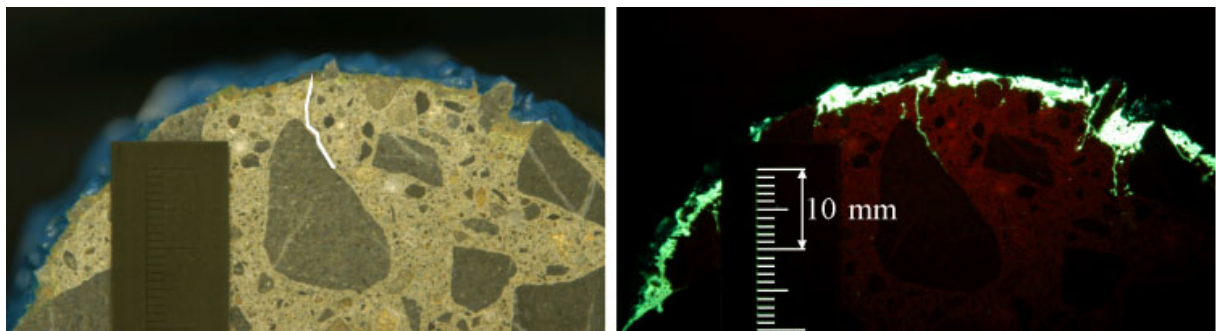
微細ひび割れの例（BL96；左 可視光，右 紫外線照射）
